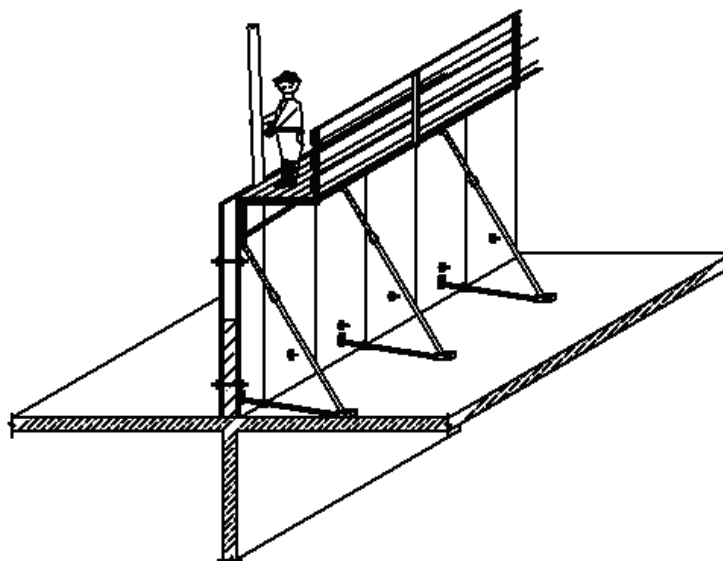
Укладка бетонной смеси в конструкцию стены с помощью бетононасоса
